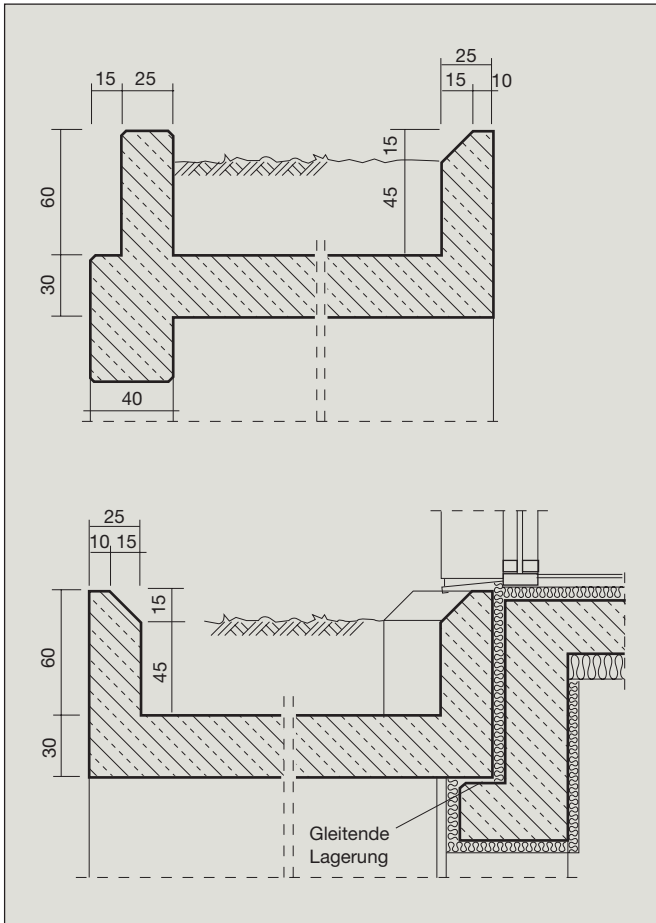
Stahlbetondach aus wu-Beton für Begrünung über einer Tiefgarage (Beispiel Bundesinnenministerium BMI in Bonn) [8]
